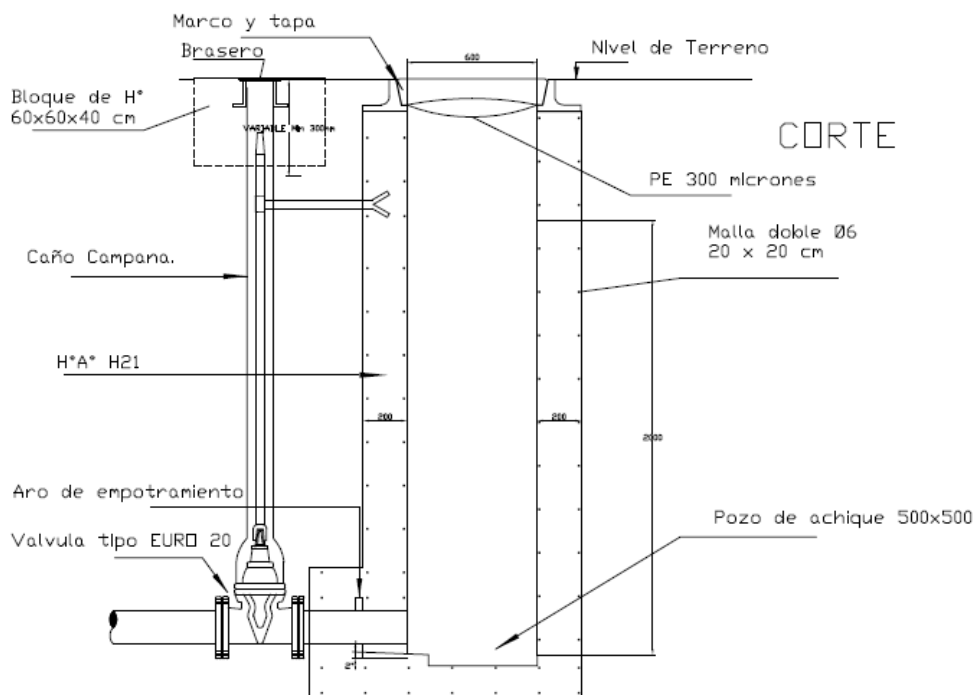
Esquema detallado de Cámara de Desagüe.
